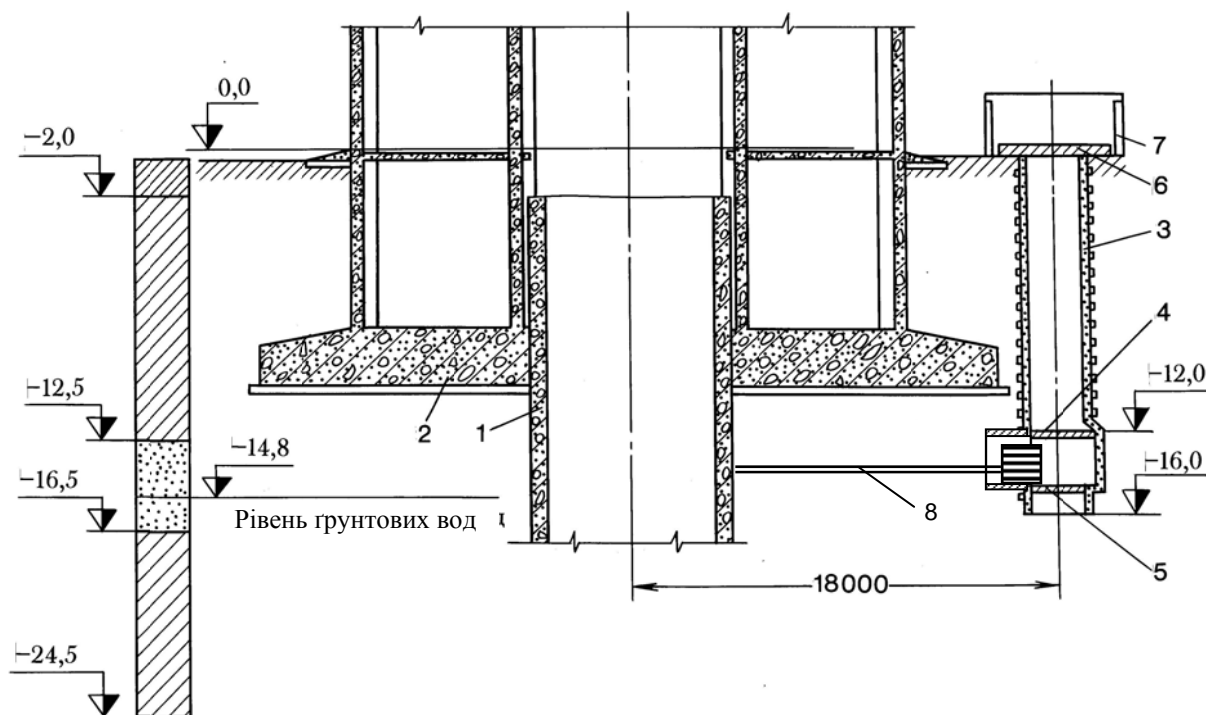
Схема способу ліквідації крену баштового копра: 1 – ствол; 2 – фундаментна плита баштового копра; 3 – шурф з металобетонним кріпленням; 4 – камера шурфа; 5 – бурова машина; 6 – захисне покриття; 7 – огорожа; 8 – свердловина
